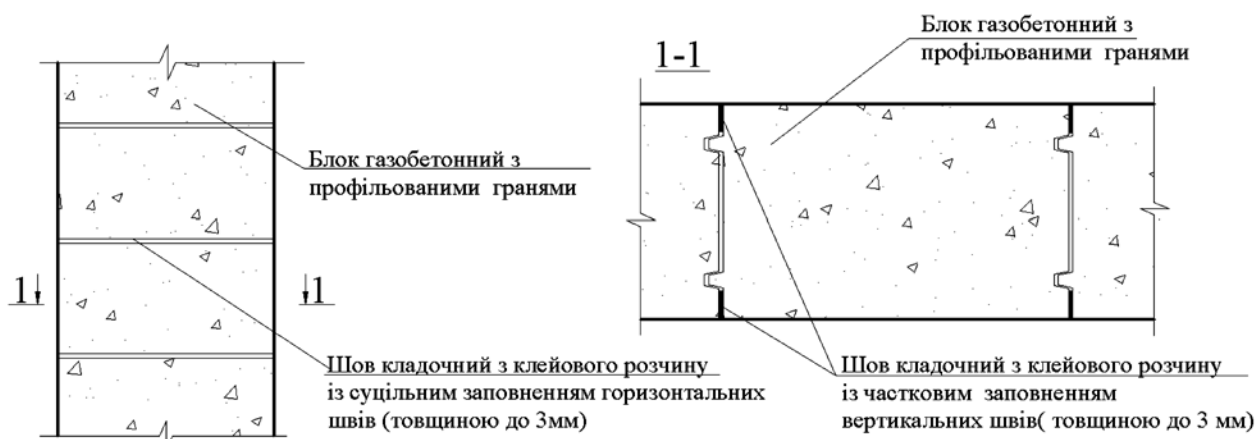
Одношарова кладка стін будівель із газобетонних блоків з профільованими гранями і суцільним заповненням горизонтальних та частковим заповненням вертикальних швів
